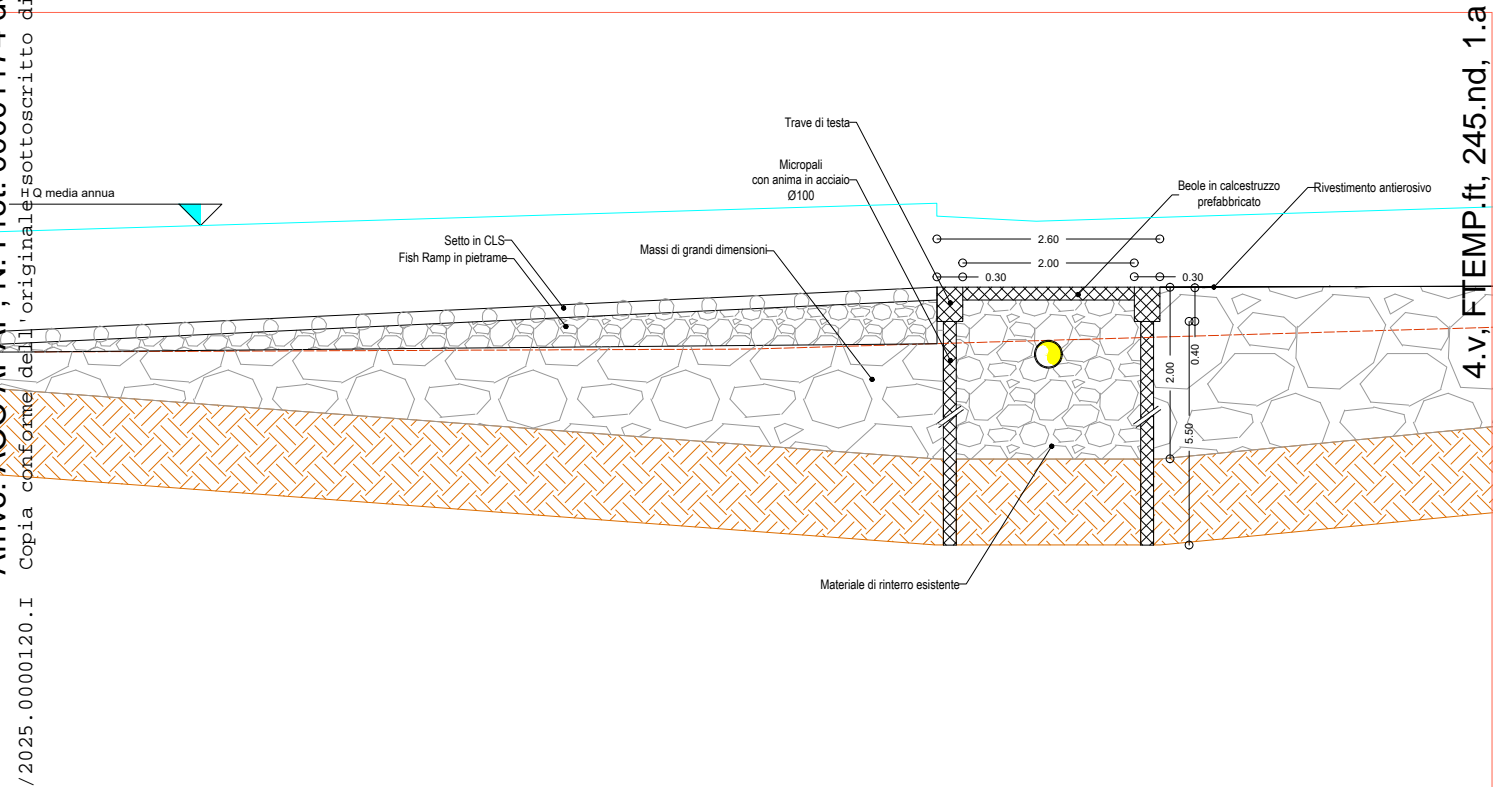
Studio di incidenza, pag. 57, e tavola progettuale: sezione longitudinale della briglia con Fish ramp in pietra
